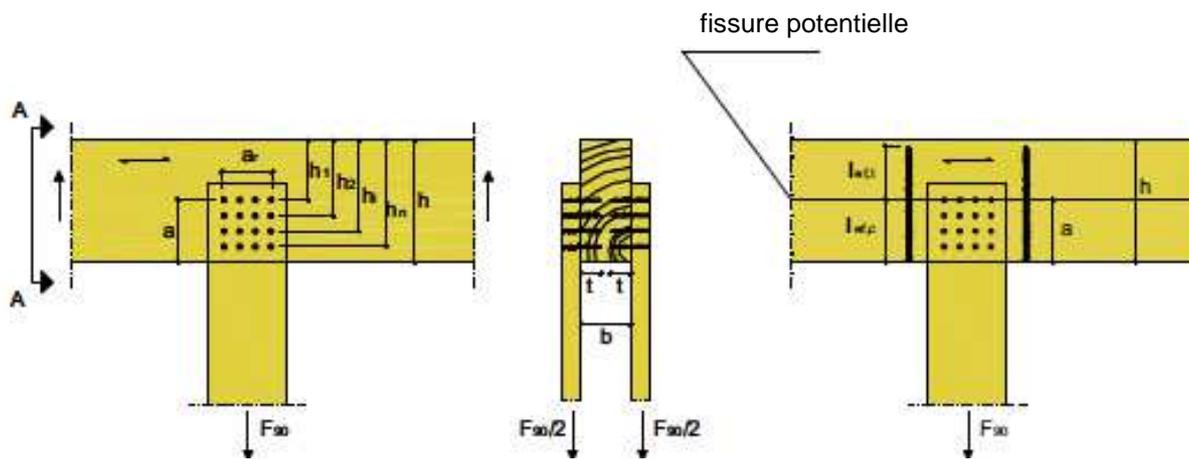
,1 : Exemple de renforcement d'un raccord transversal
